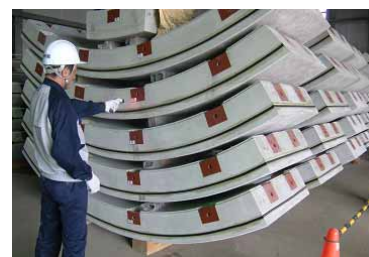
受入れ履歴情報の読み取り状況（ヤード）
